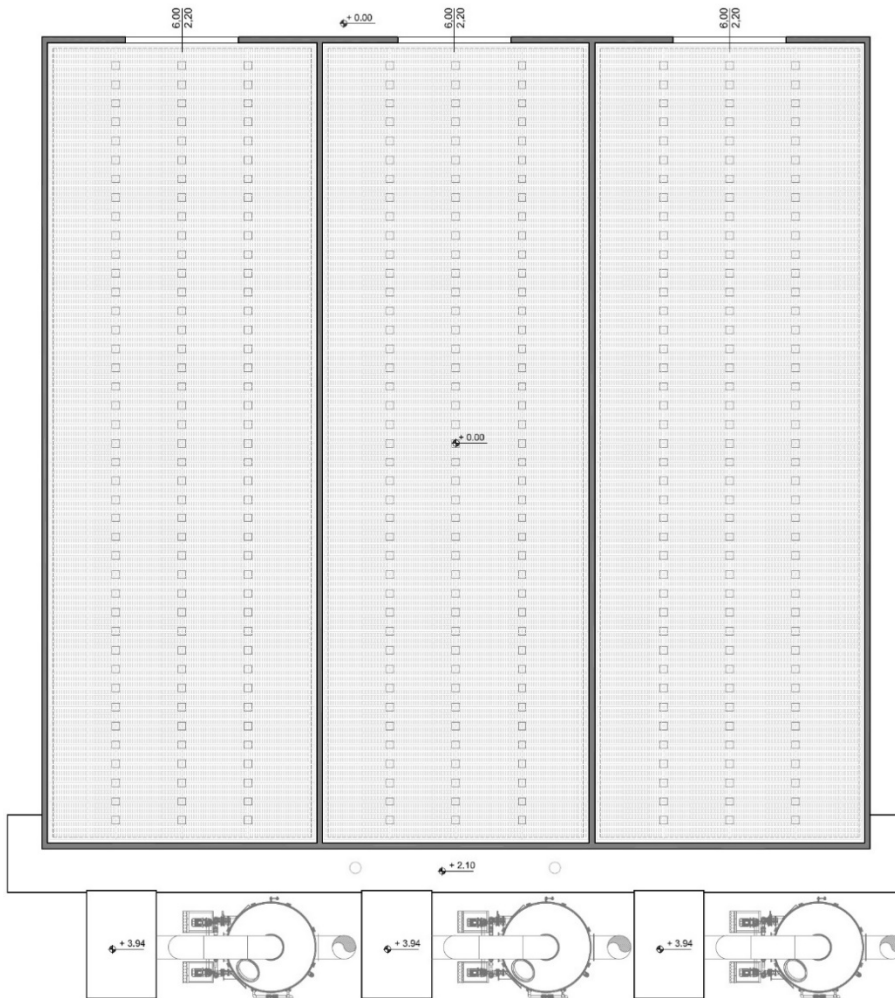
Planimetria del Biofiltro (nel lato Nord le aperture di accesso alle tre vasche, sul lato Sud i locali a protezione degli impianti e gli scrubber)
